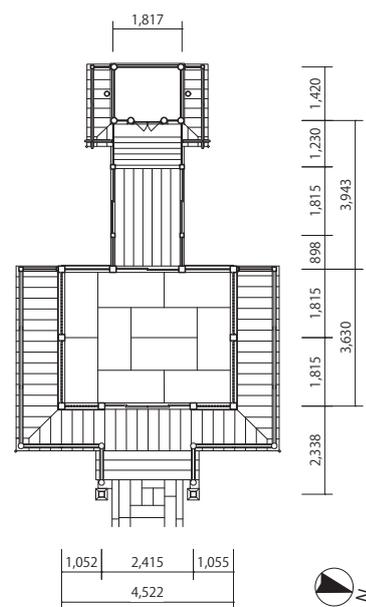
拝殿・幣殿・本殿平面図 1 : 200
